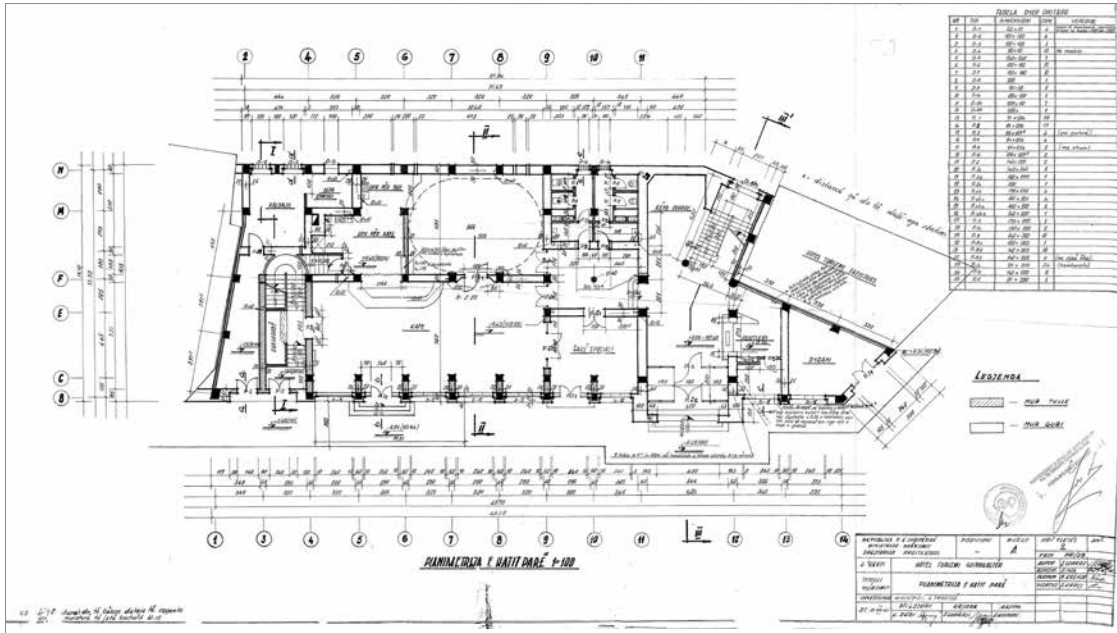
Skënder Luarasi, Çajupi Hotel, Gjirokastrë, 1961, ground floor plan (TCAC)
